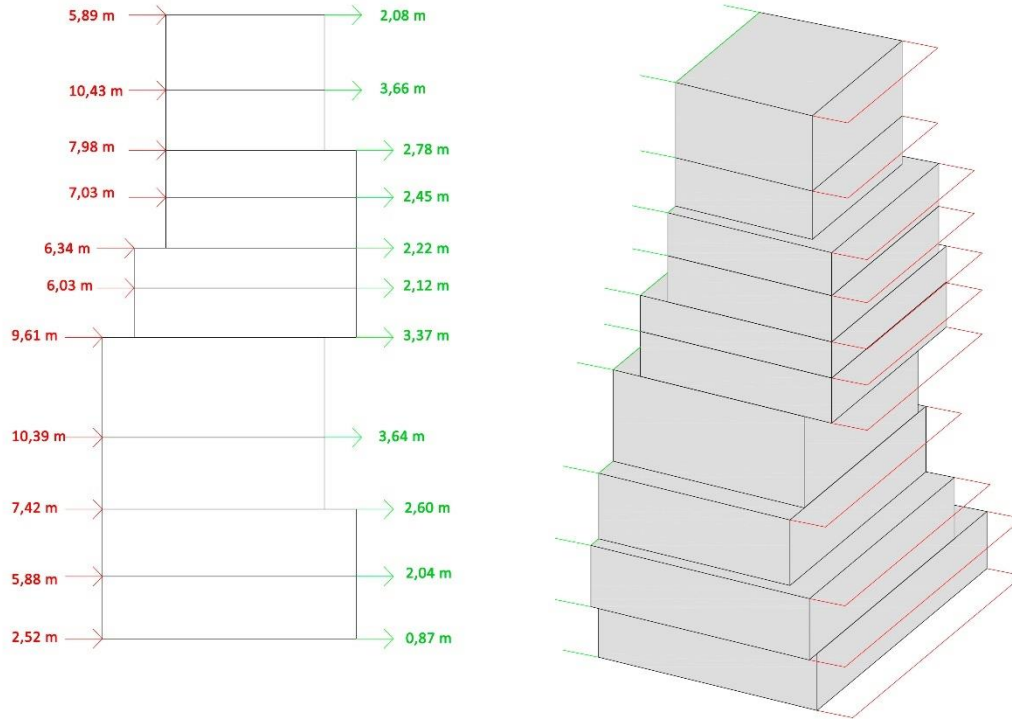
Cargas de viento horizontal aplicada en las vigas de borde en la dirección Y. (Elaboración propia).
